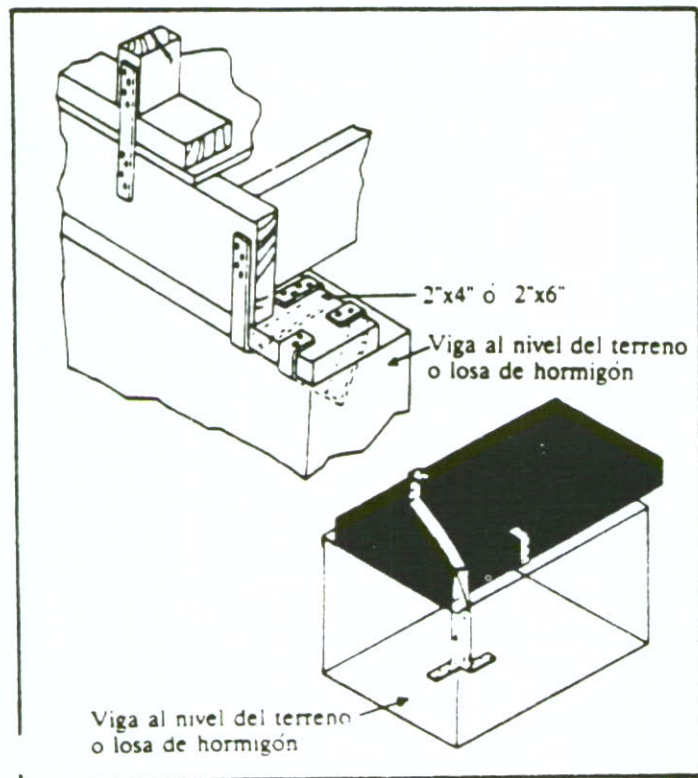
Uso de grapas o amarres para conectar una placa del fondo a un piso nuevo de hormigón
